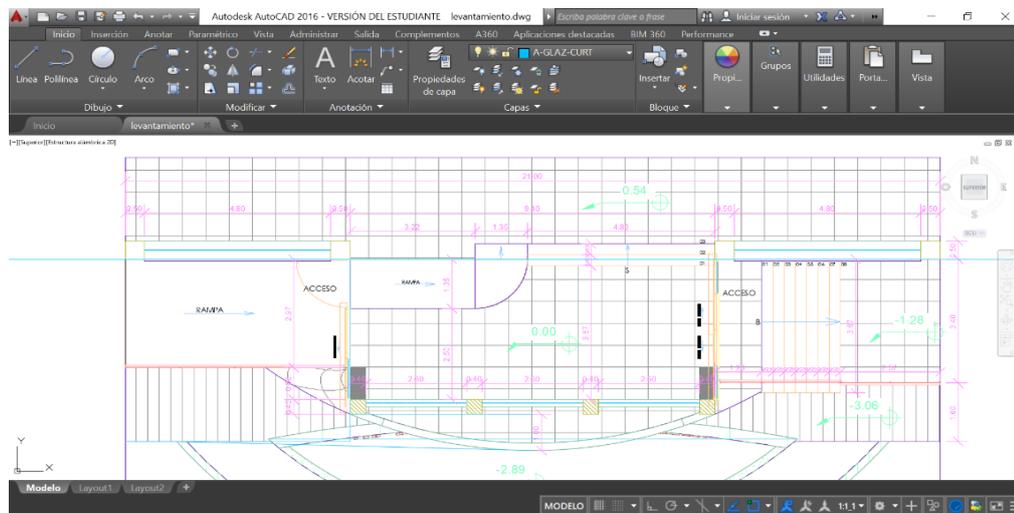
Digitalización del plano de planta de la parte central del edificio Cornelio Merchán
